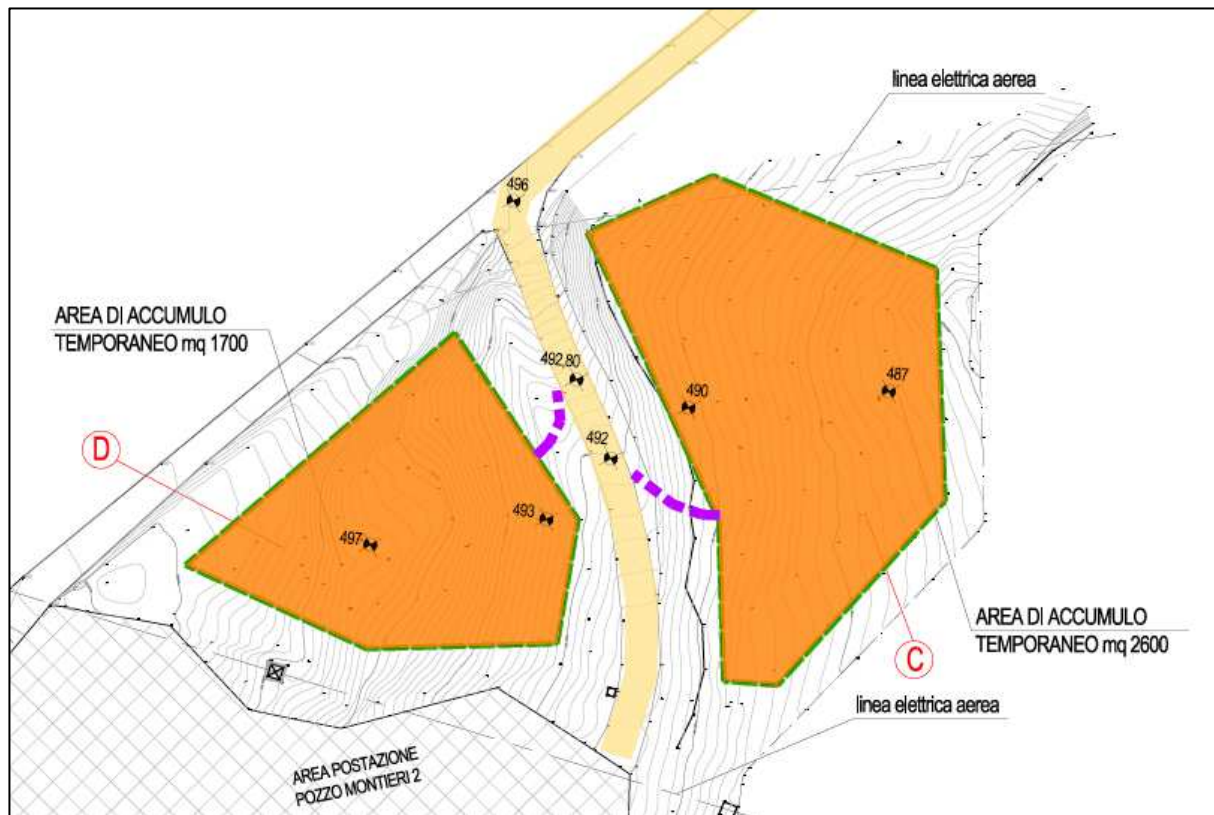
Planimetria del cantiere civile destinato ad area di accumulo temporaneo delle terre di scavo per riutilizzo. La postazione visibile è Montieri 2 - Stralcio della tavola R35045_Pcant.
